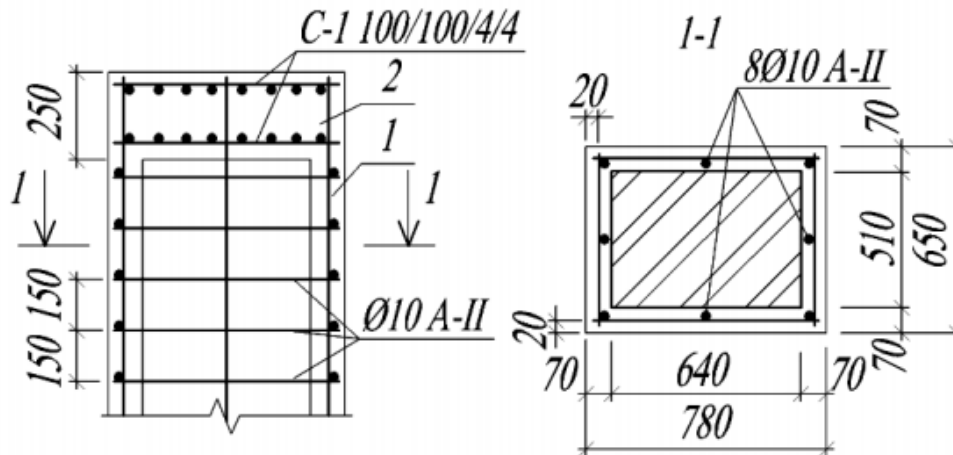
Схема усиления кирпичного столба железобетонной обоймой: 1 – железобетонная обойма из бетона класса В15; 2 – распределительная железобетонная плита, бетонизируемая одновременно с обоймой
